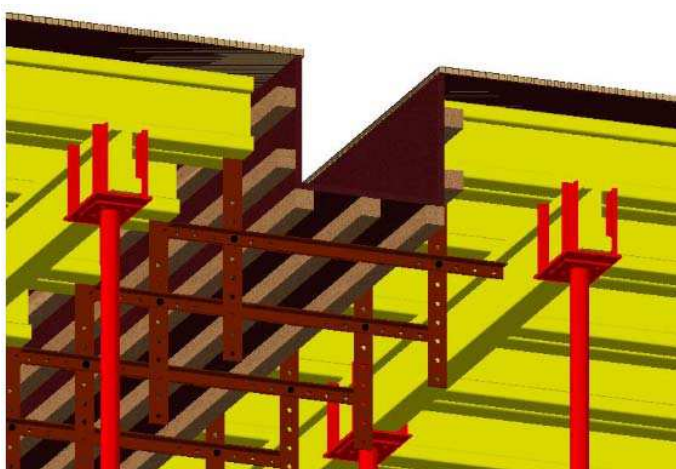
Опалубка монолитных балок с использованием струбцины
